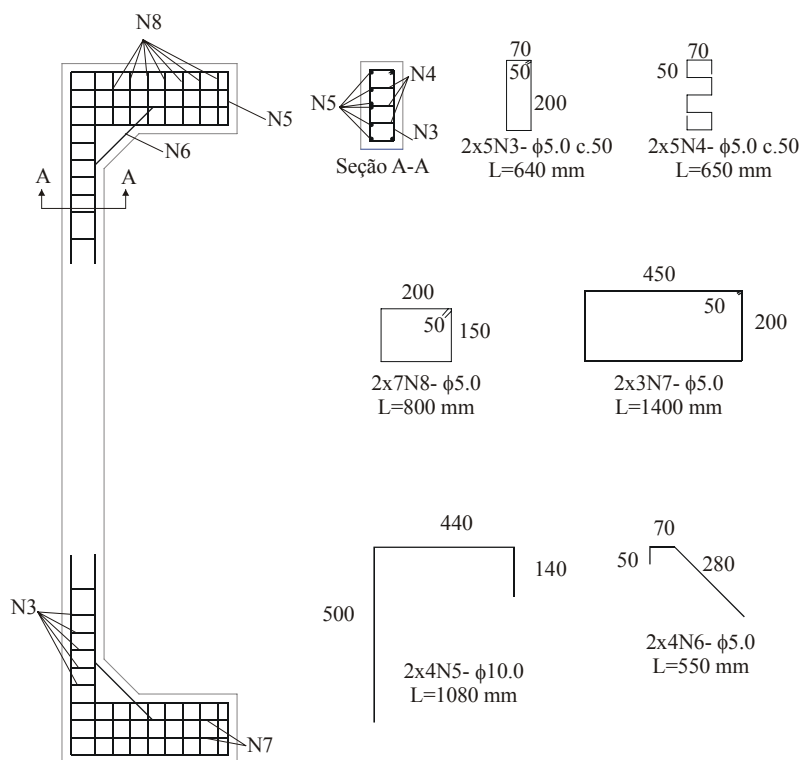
Detalhamento de armaduras do grupo PCS
